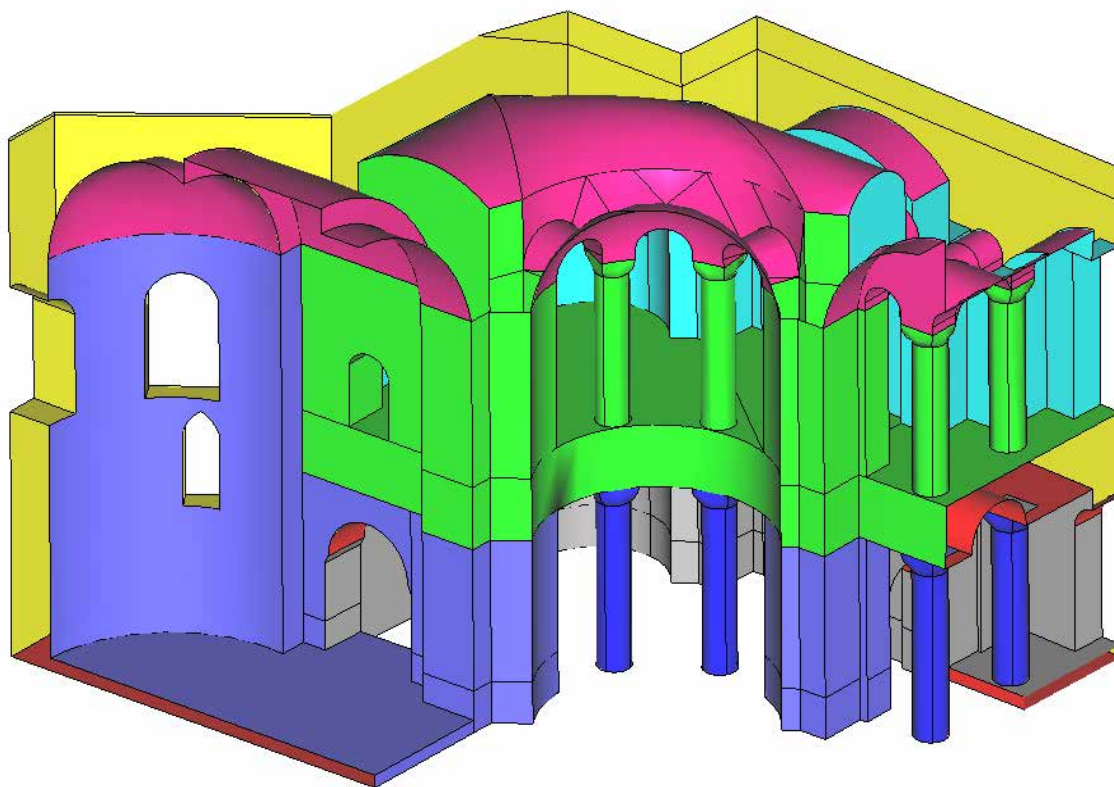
Vista interior de la planta baja y primer piso del modelo definitivo de la mezquita
